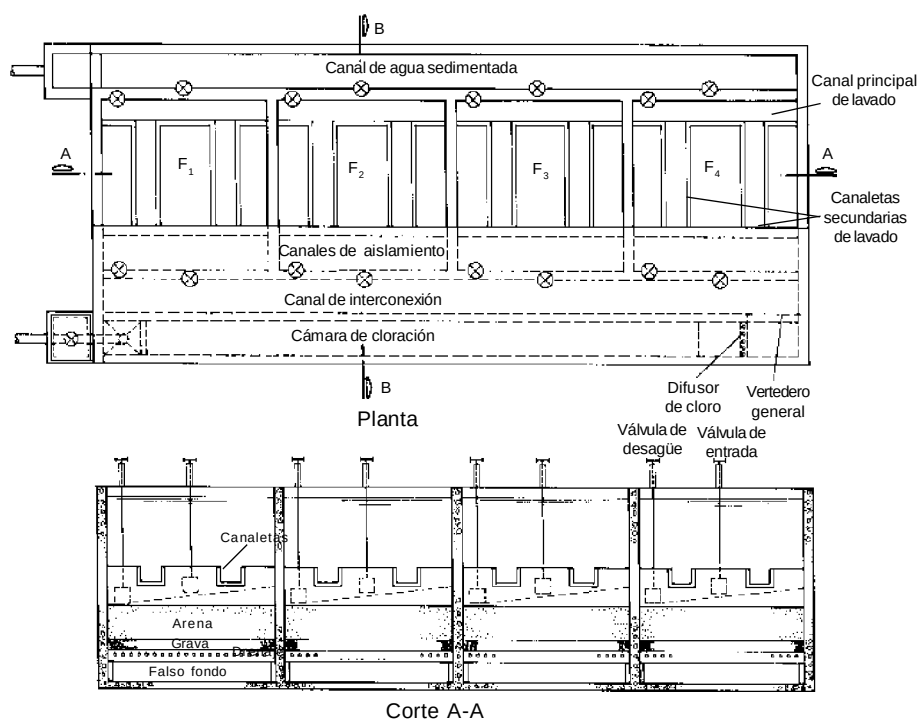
Vista en planta de una batería de filtros de tasa declinante y lavado mutuo (8)
